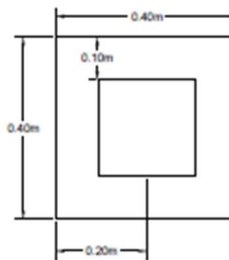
Diseño Estructural para Contenedores – Detalle de Columnas de Cimentación
